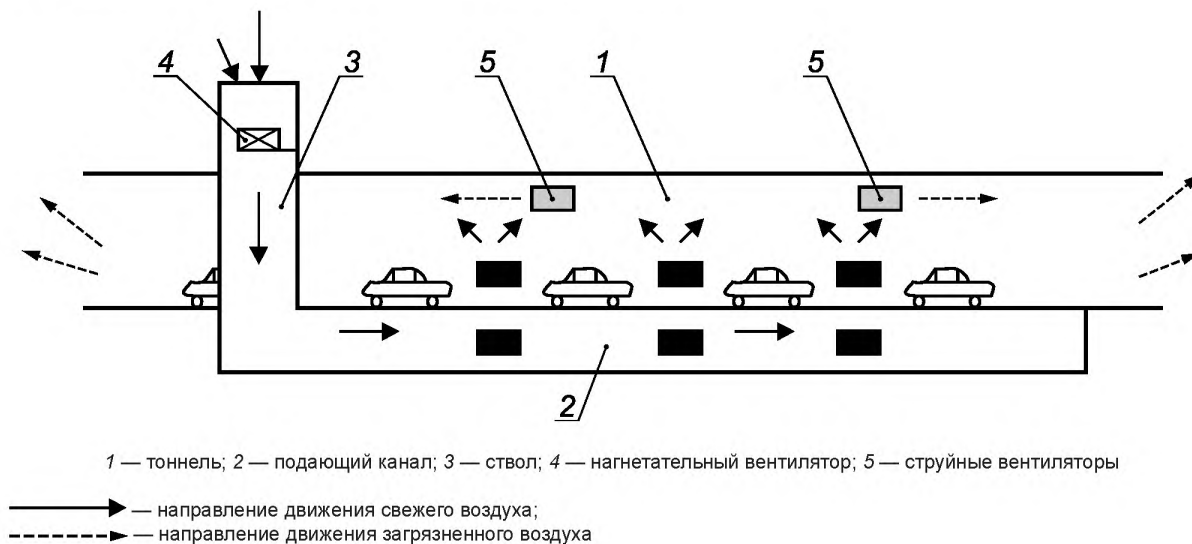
Продольно-поперечная схема вентиляции с использованием струйных вентиляторов
